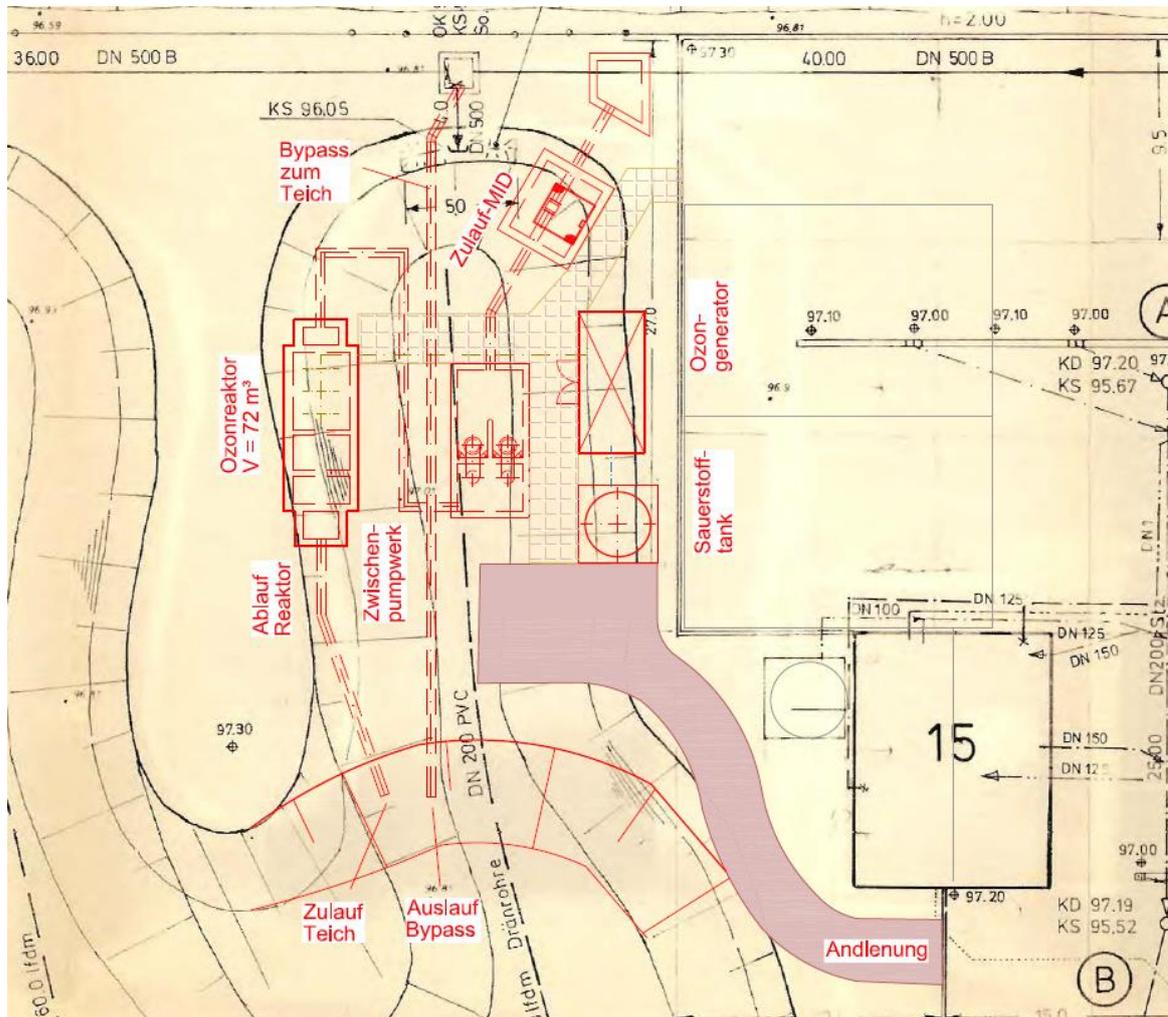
Lageplan Variante 3: Ozonierung
